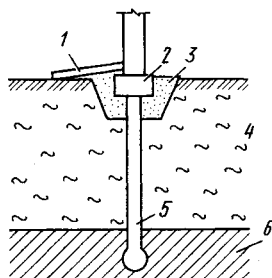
Фундамент из буронабивных свай с уширенной пятой в условиях набухающих и испытывающих усадку грунтов:
